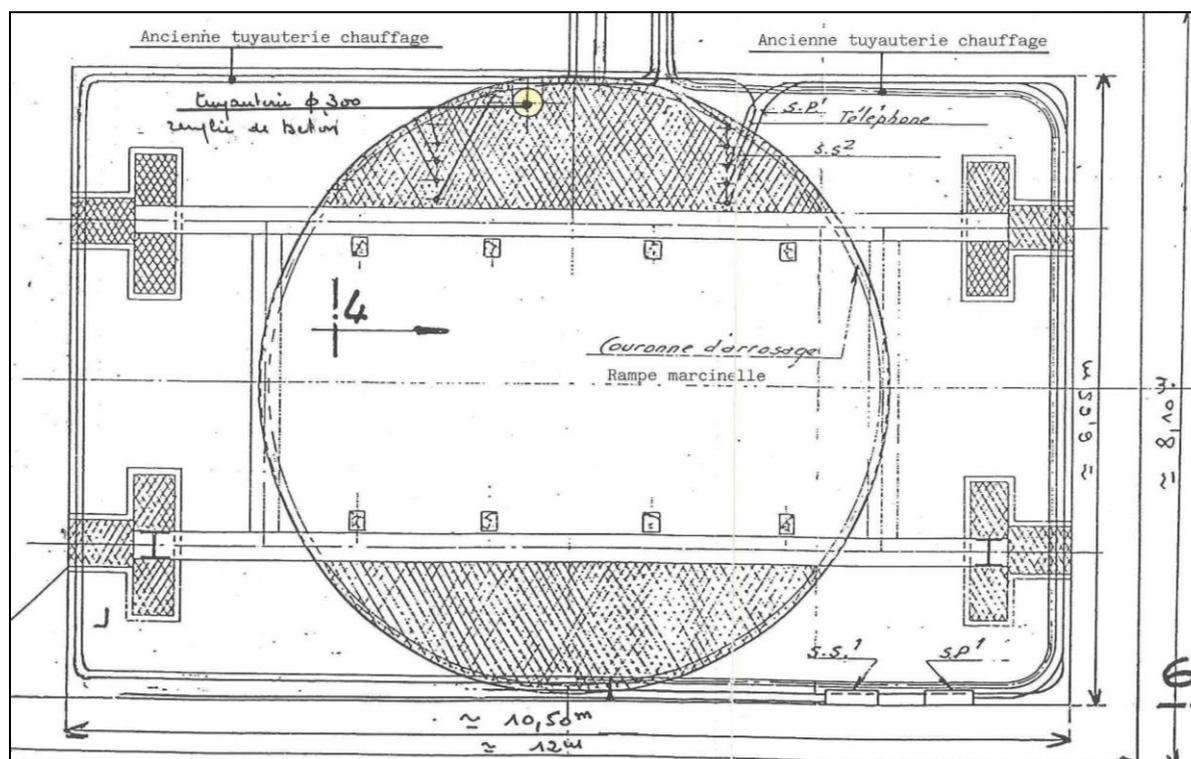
Plan des fondations au niveau du puits 19 (source BRGM-DPSM)
